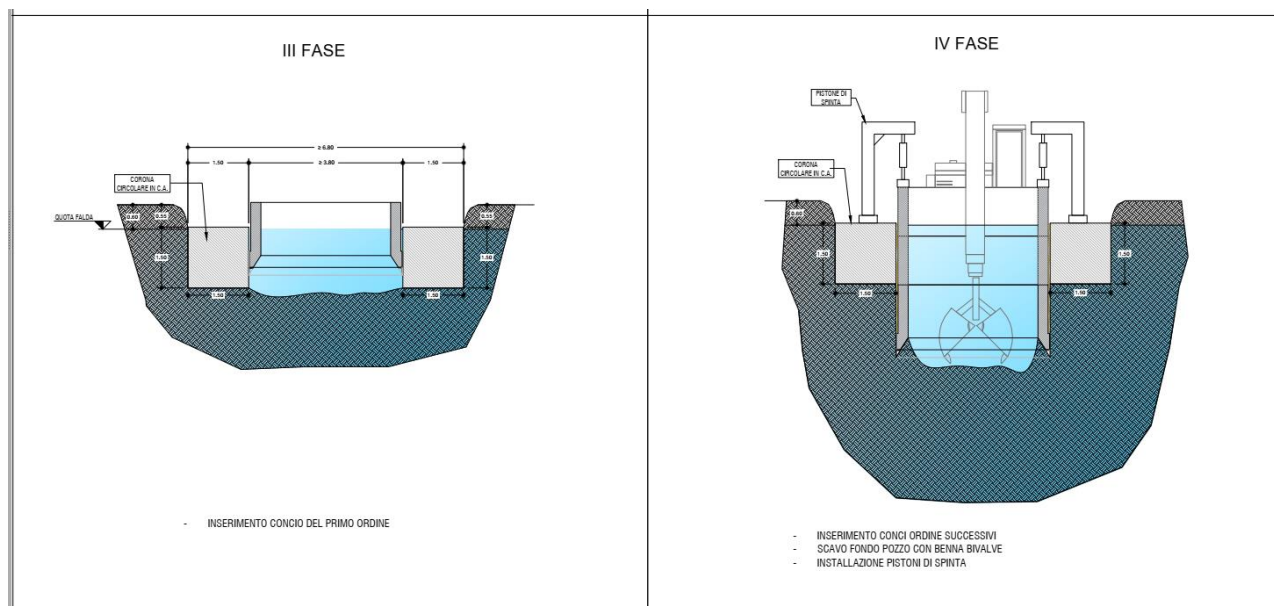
B : Schema tecnico realizzazione pozzo autoaffondante
